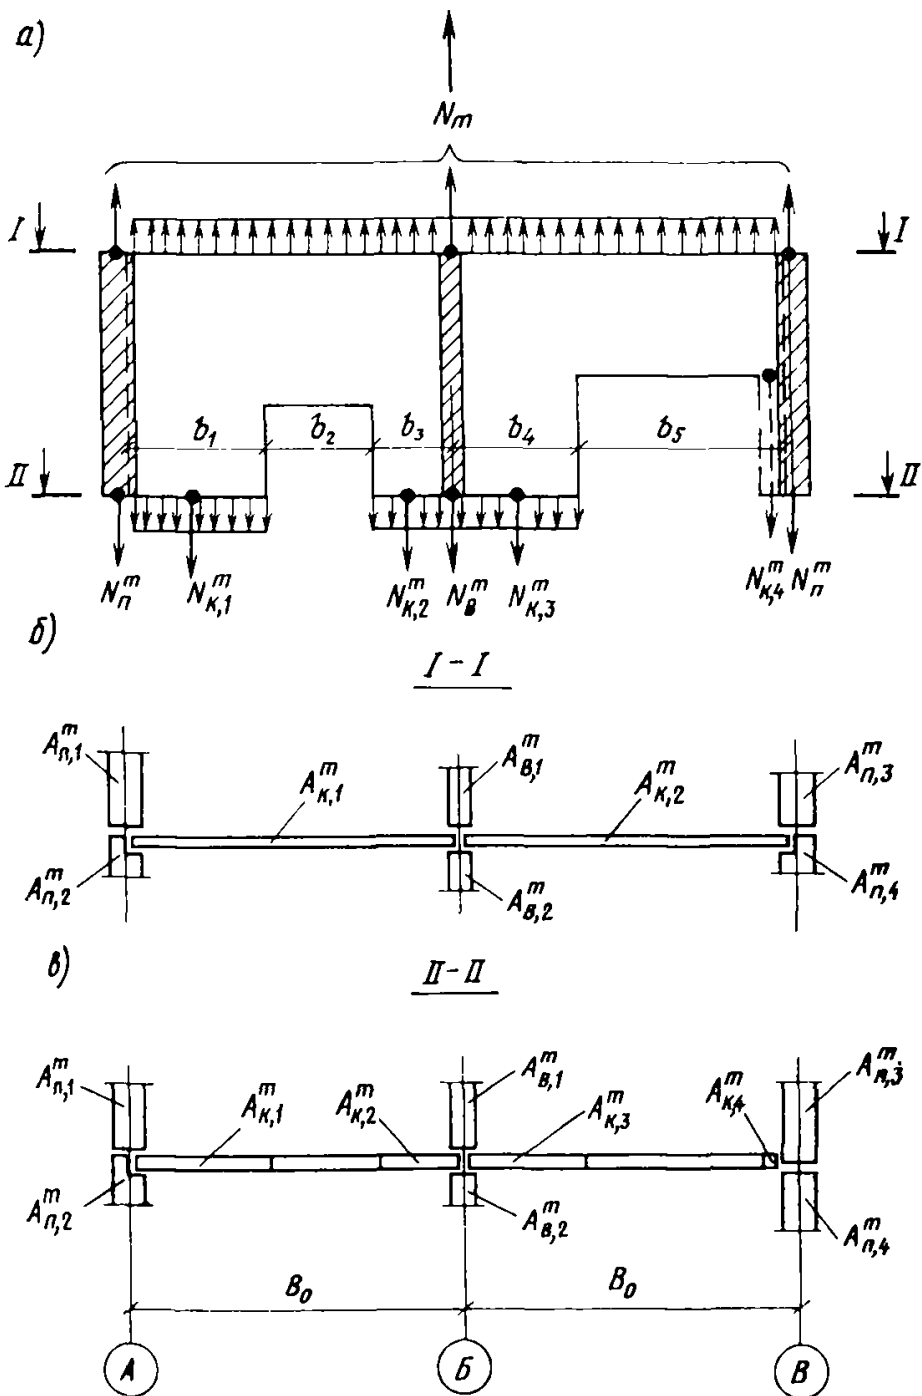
Распределение температурных усилий в сечениях стен и перекрытий без проемов и с проемами:
